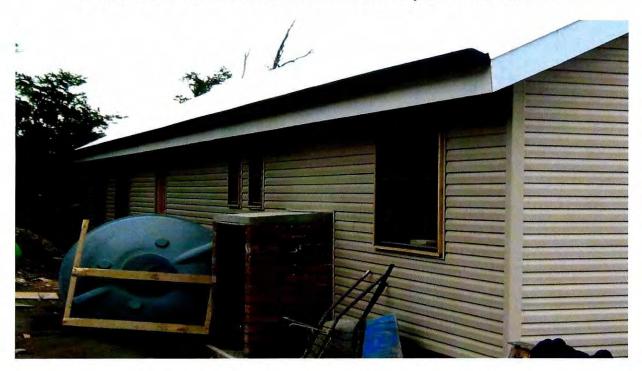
Fachada sur ejecutada con 5 ventanas.
